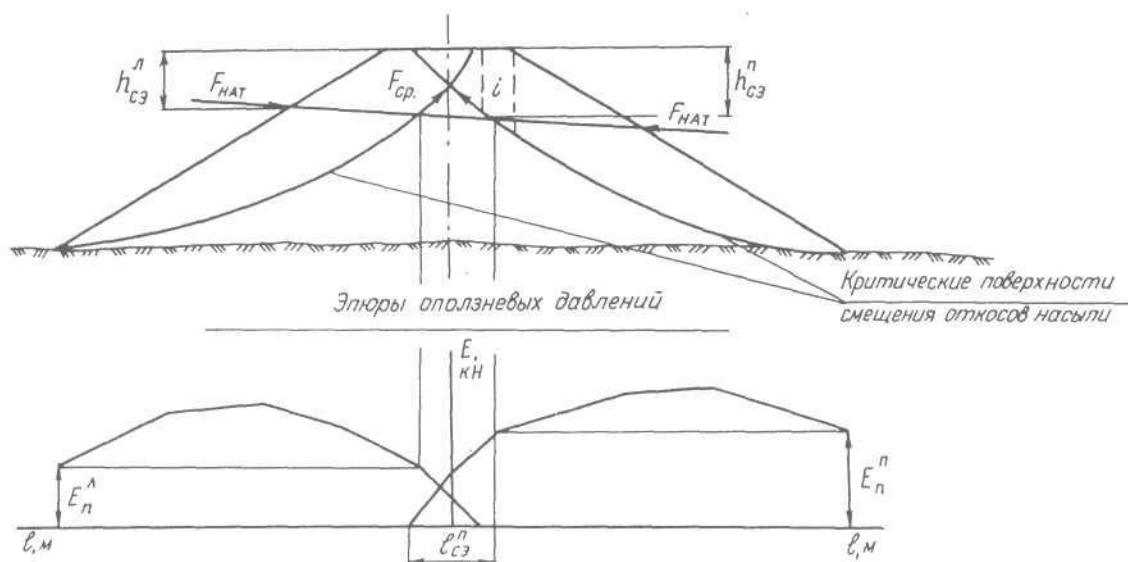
Схема розрахунку посилення насипу стягуючими елементами
